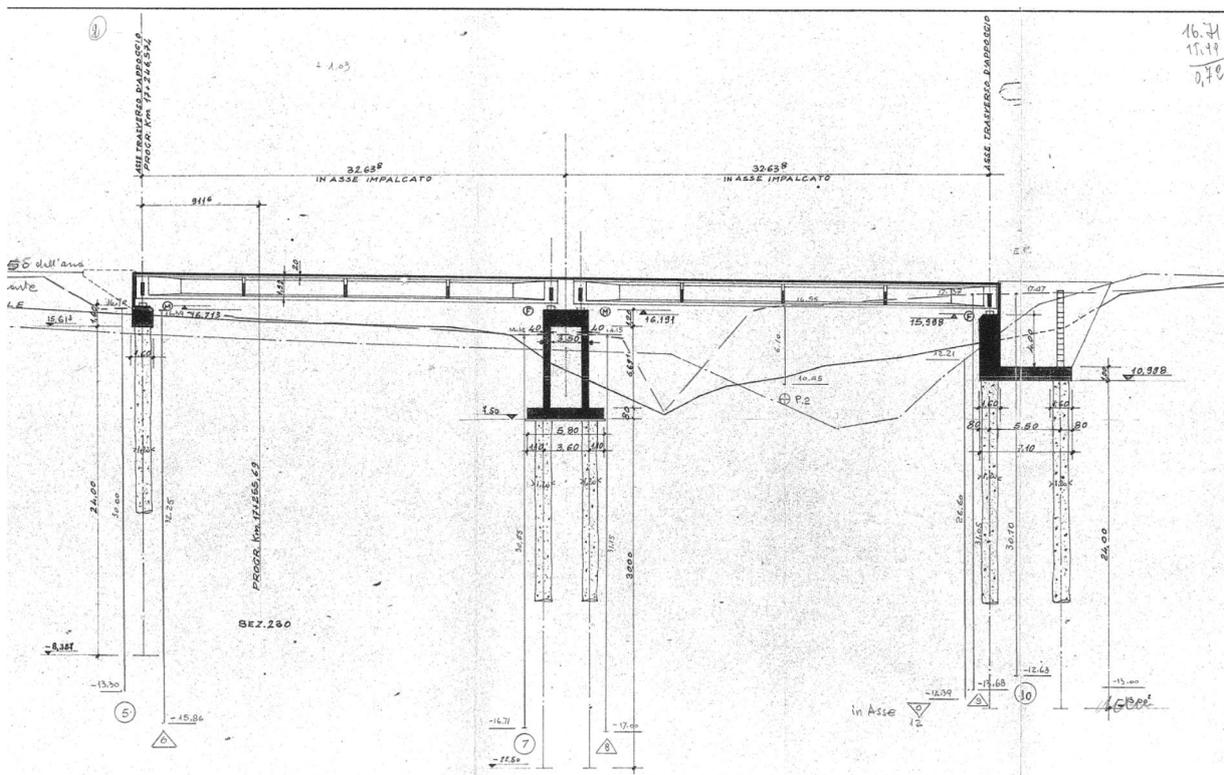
Viadotto Cacchione – Profilo longitudinale di Carreggiata Sud (dalla Contabilità lavori) (Doc.Ref.[7])
